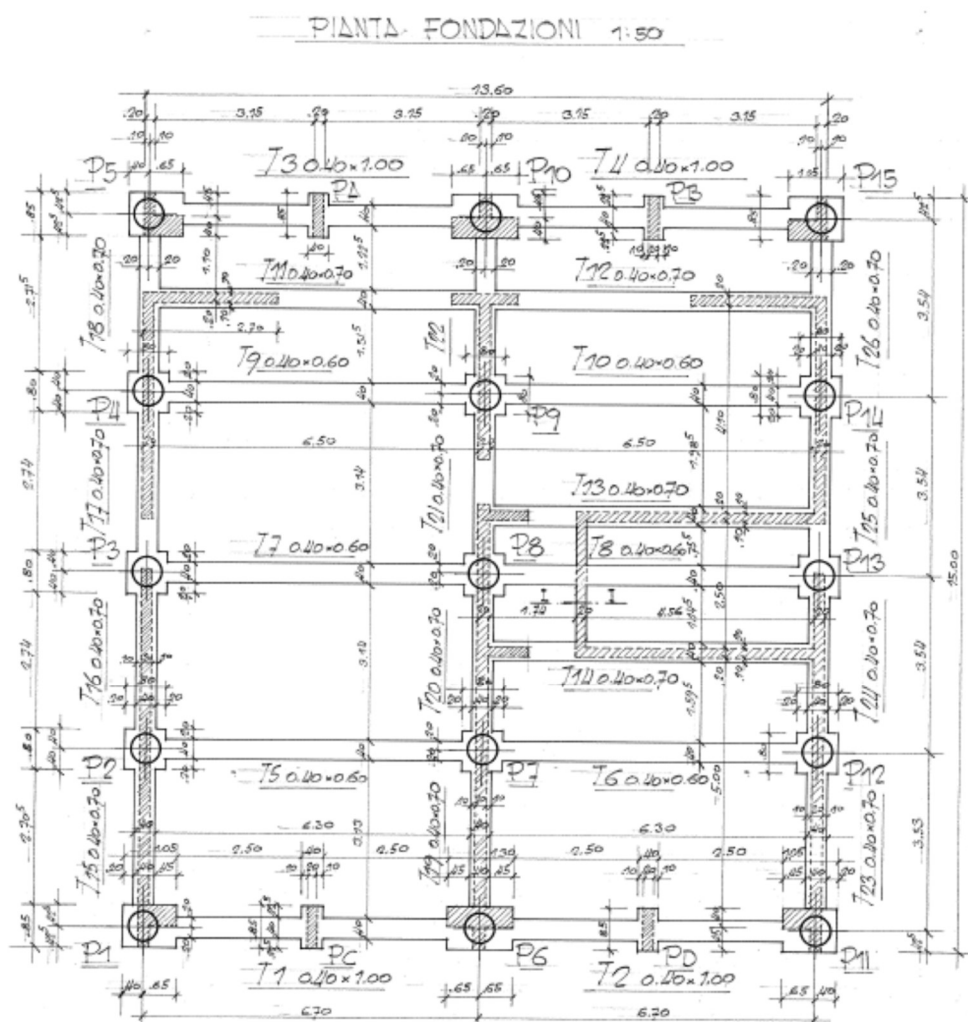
Progetto di esecutivo del 1985 – Pianta delle fondazioni
